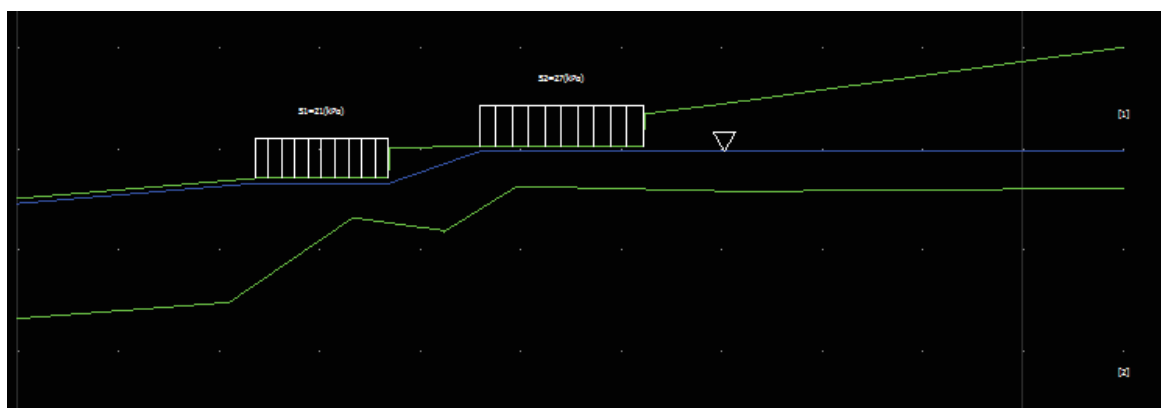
Sezione del modello geotecnico del Profilo A-B nella condizione drenata di Stato Limite di salvaguardia della Vita e di Danno.
